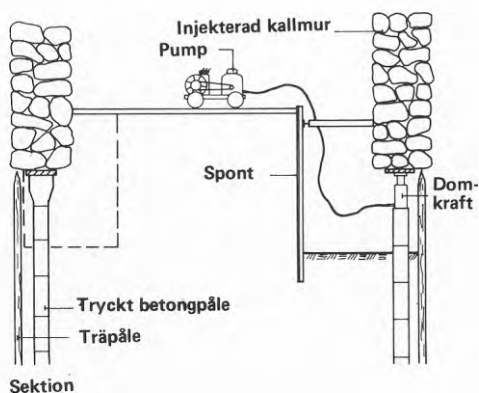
Grundförstärkning genom tryckning av delpälars under befintliga grundmurar.
